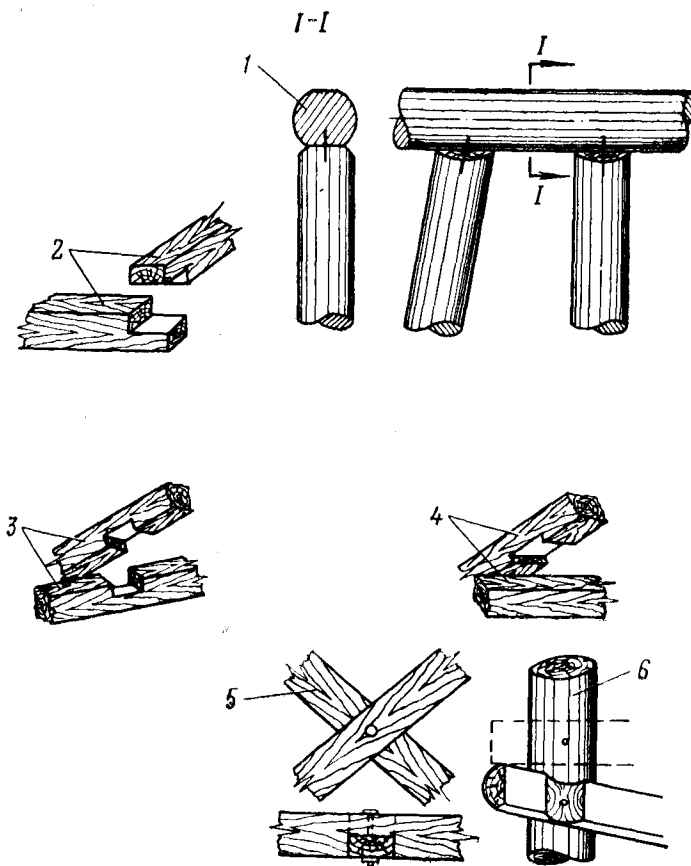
Соединение деревянных элементов торцами поперек волокон:
